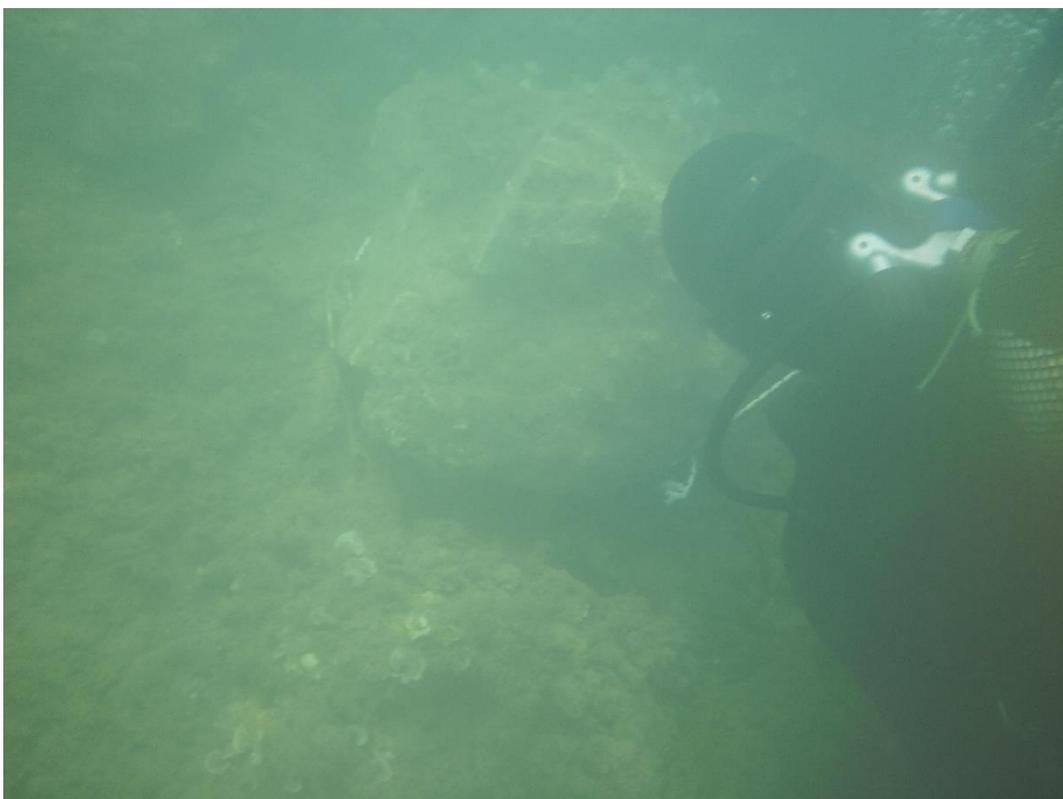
fondale Diga Est fasi di rilievo e documentazione
